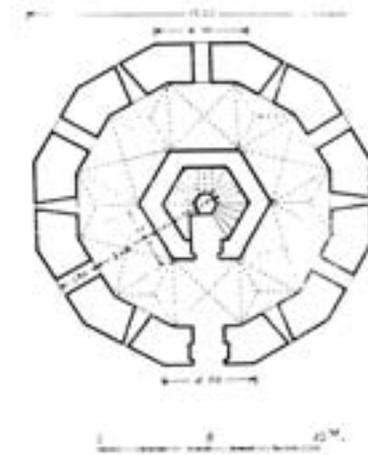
Sevilla. Torre del Oro. Planta (L. Torres Balbás).
